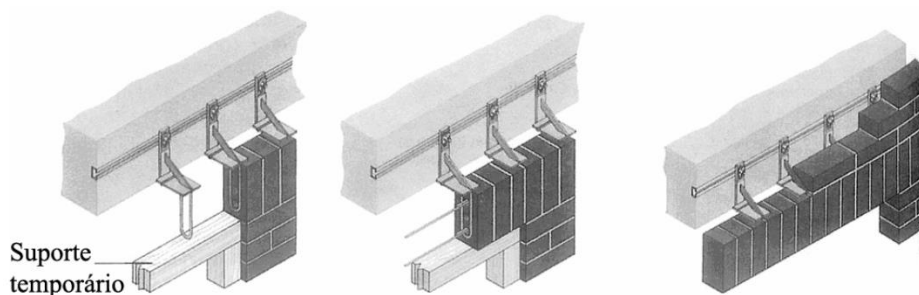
Sistema de suspensão para vãos de fachadas em tijolo com face à vista [47]
